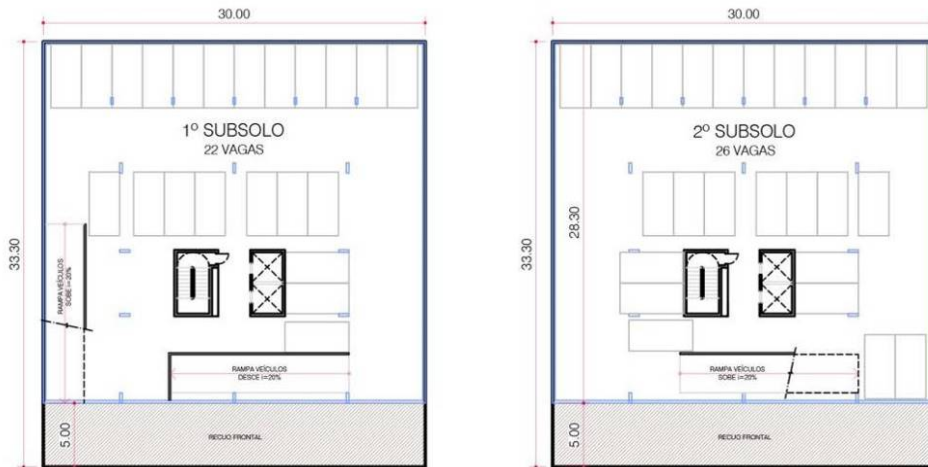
Plantas baixas e corte de edifício misto em lote de 1000m²
